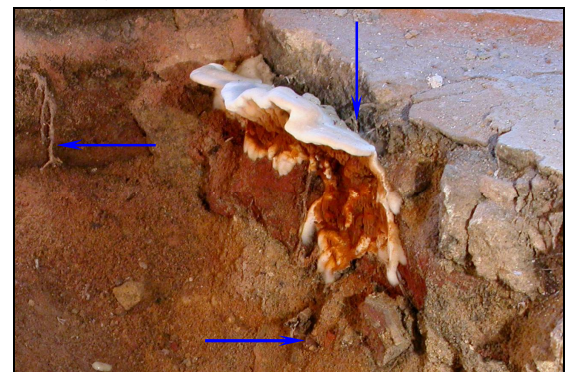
Stränge (↑) des Echten Hausschwammes versorgen einen frischen Fruchtkörper; Bodenbelag aufgeschlagen; die Stränge wachsen in den Fugen.
